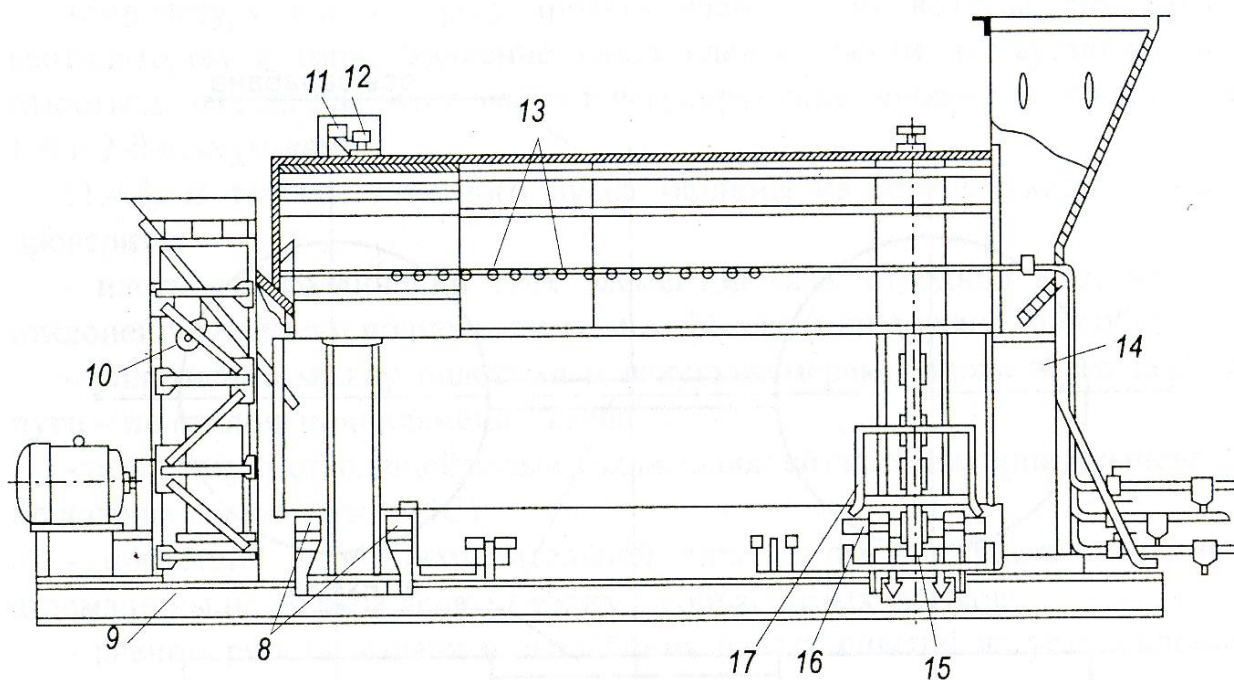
Барабанний змішувач СБ 2,8х6,0 , вид збоку
